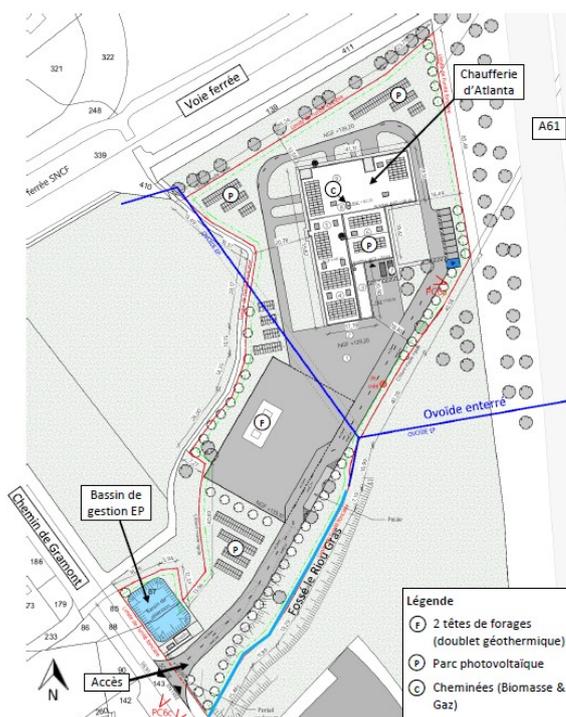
plan de masse du projet au niveau du site d'Atlanta (source : étude d'impact)
